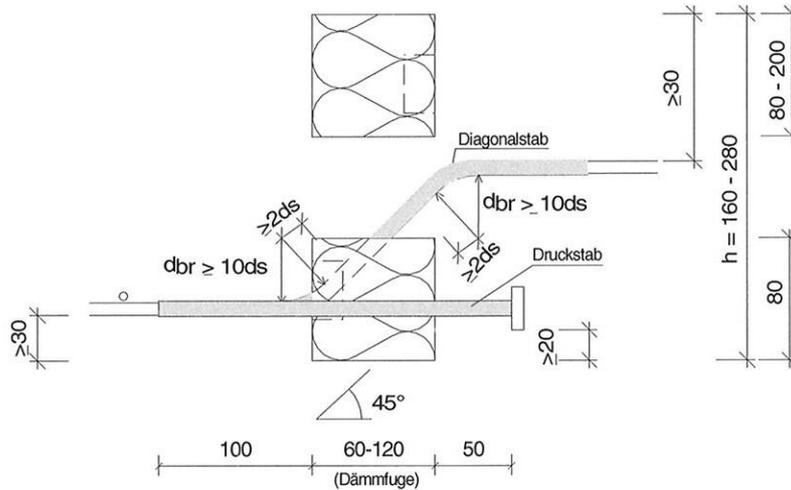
Egccobox Plattenelement Typ PV-D-F
